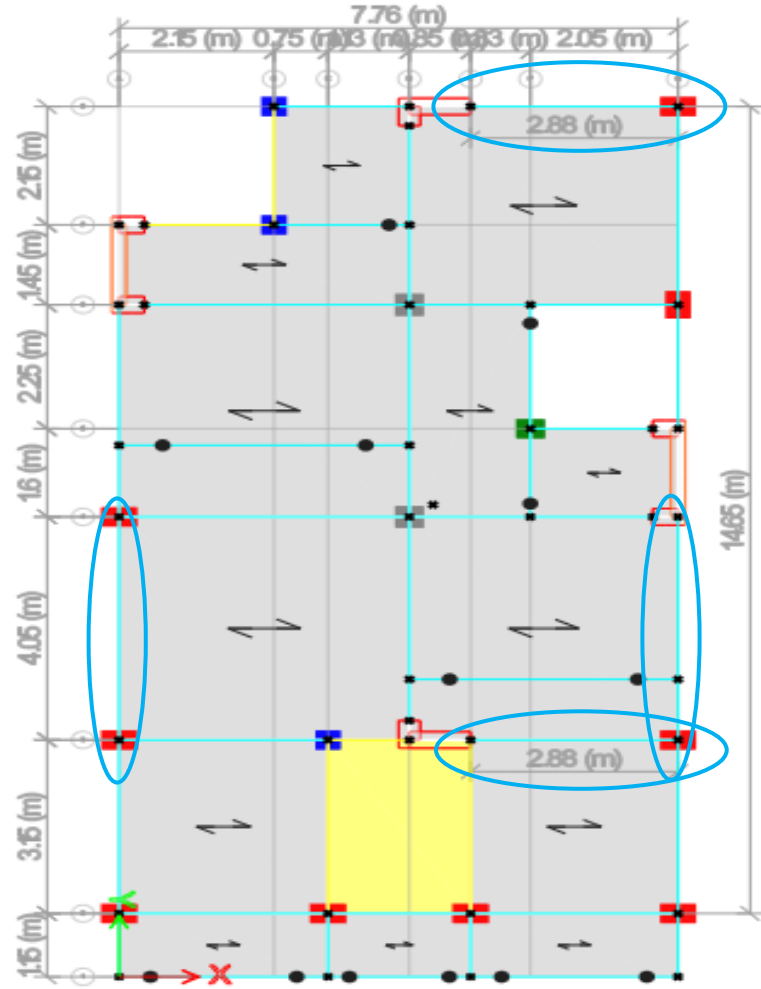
Plano en planta donde serían ubicados los disipadores fluido viscoso.
